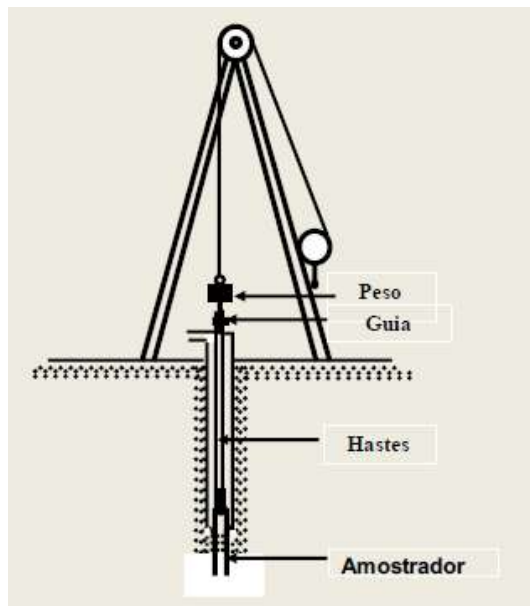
Demonstração do tripé utilizado no ensaio SPT
